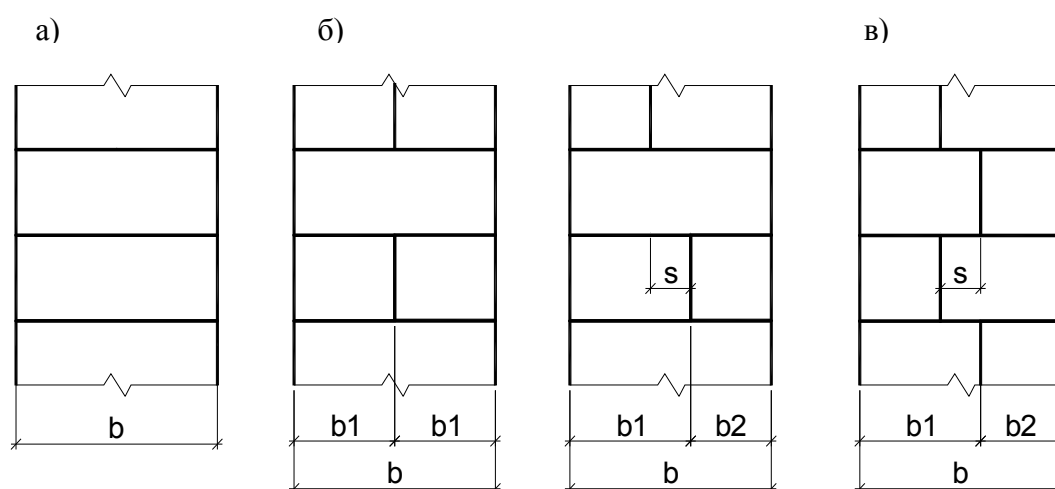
Раскладка блоков из ячеистого бетона в однослойных стенах
